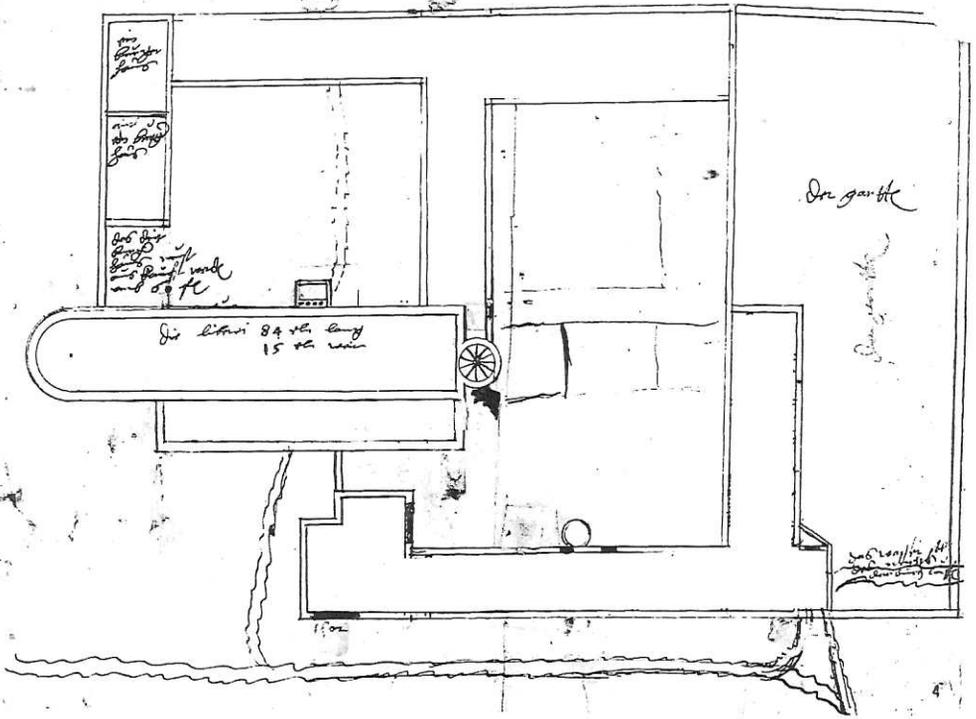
(4) Dachgeschoß (Hauptschiff der Kirche)
